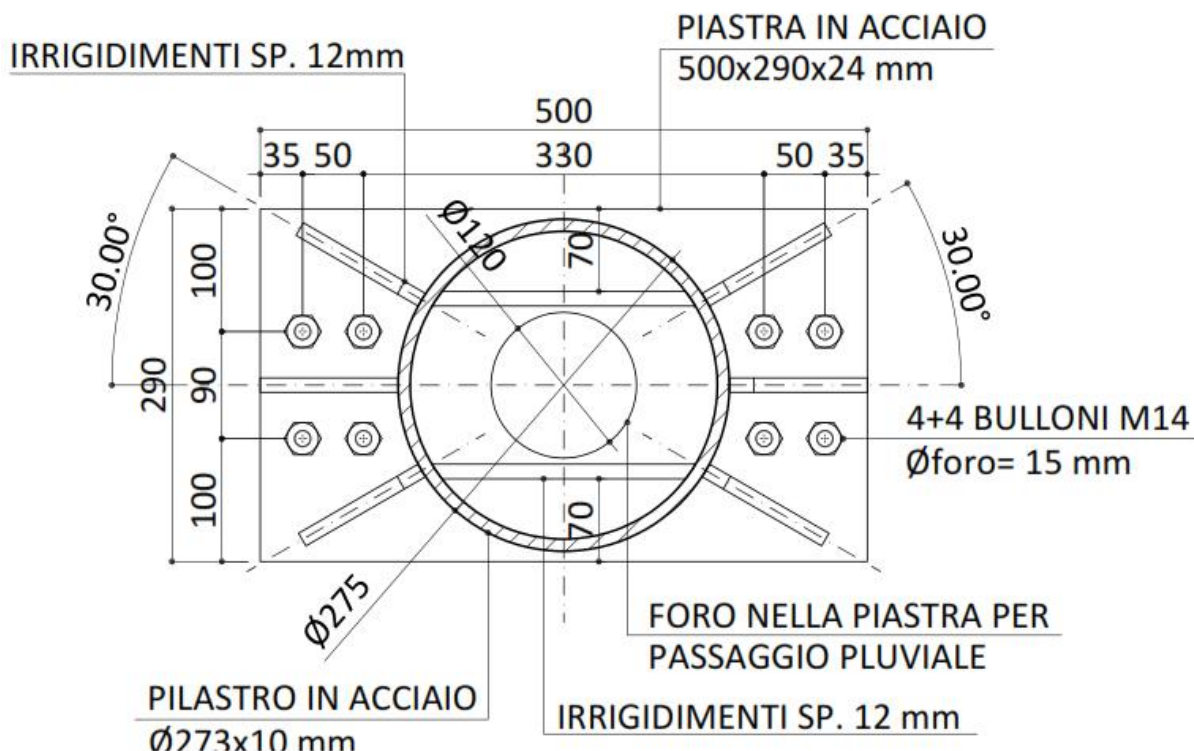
Dettaglio del collegamento in acciaio alla base del pilastro
